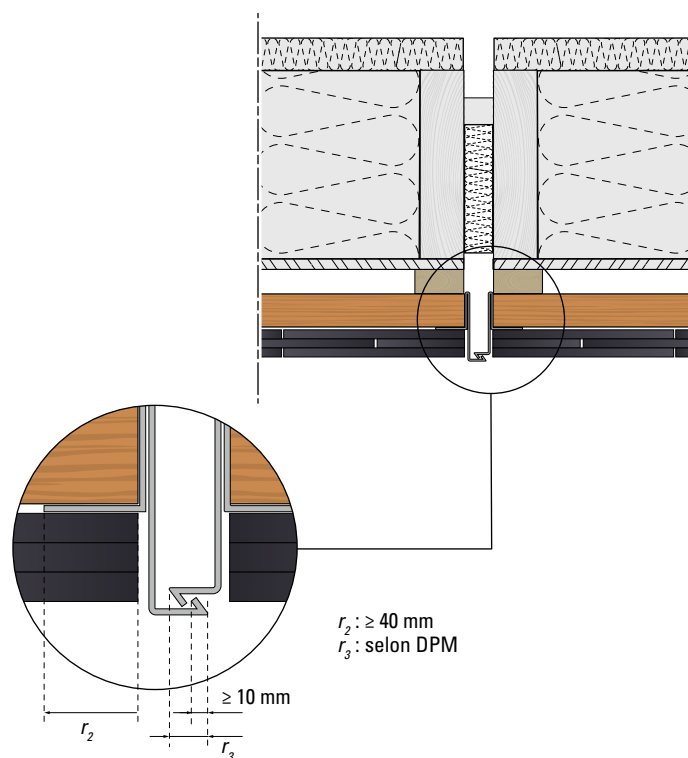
Détail du traitement du joint de dilatation avec profilés métalliques
